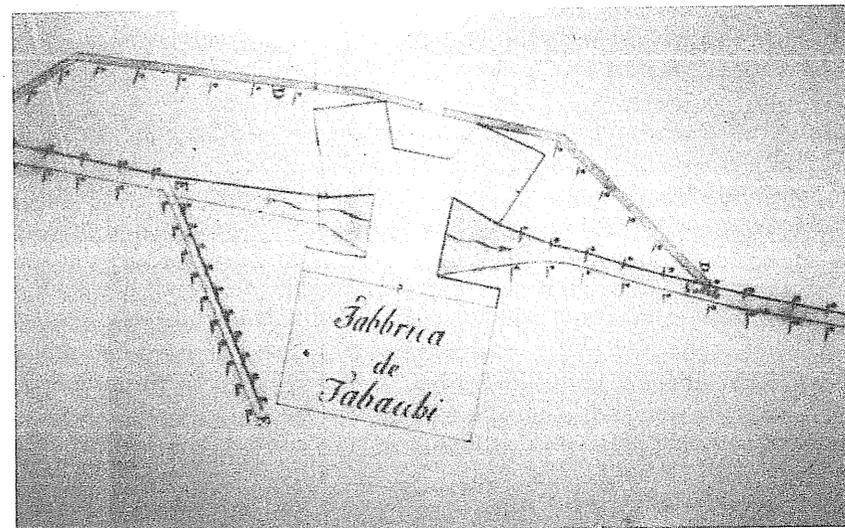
Pianta della fabbrica dei tabacchi di Chiaravalle, eseguita nel 1822. Archivio di Stato di Roma, Collezione disegni e piante, I.
